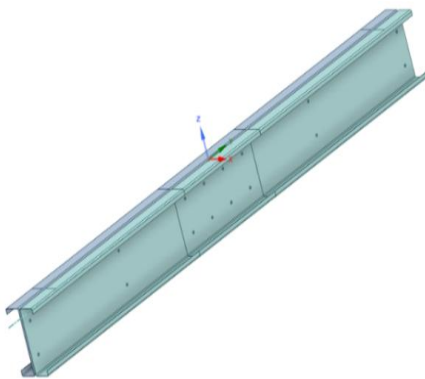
Permodelan Baut dan Mur M12 Grade 8.8
